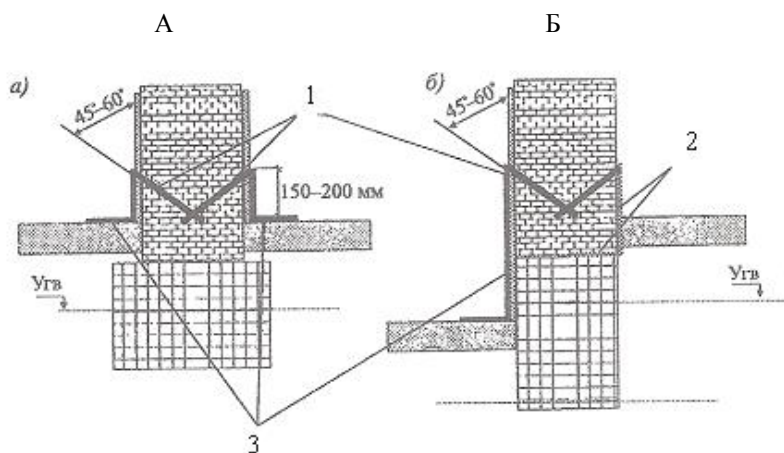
Гидроизоляция внутренних (А) и наружных стен (Б) подвального помещения здания методом отсечки с использованием пенетрирующей добавки:
